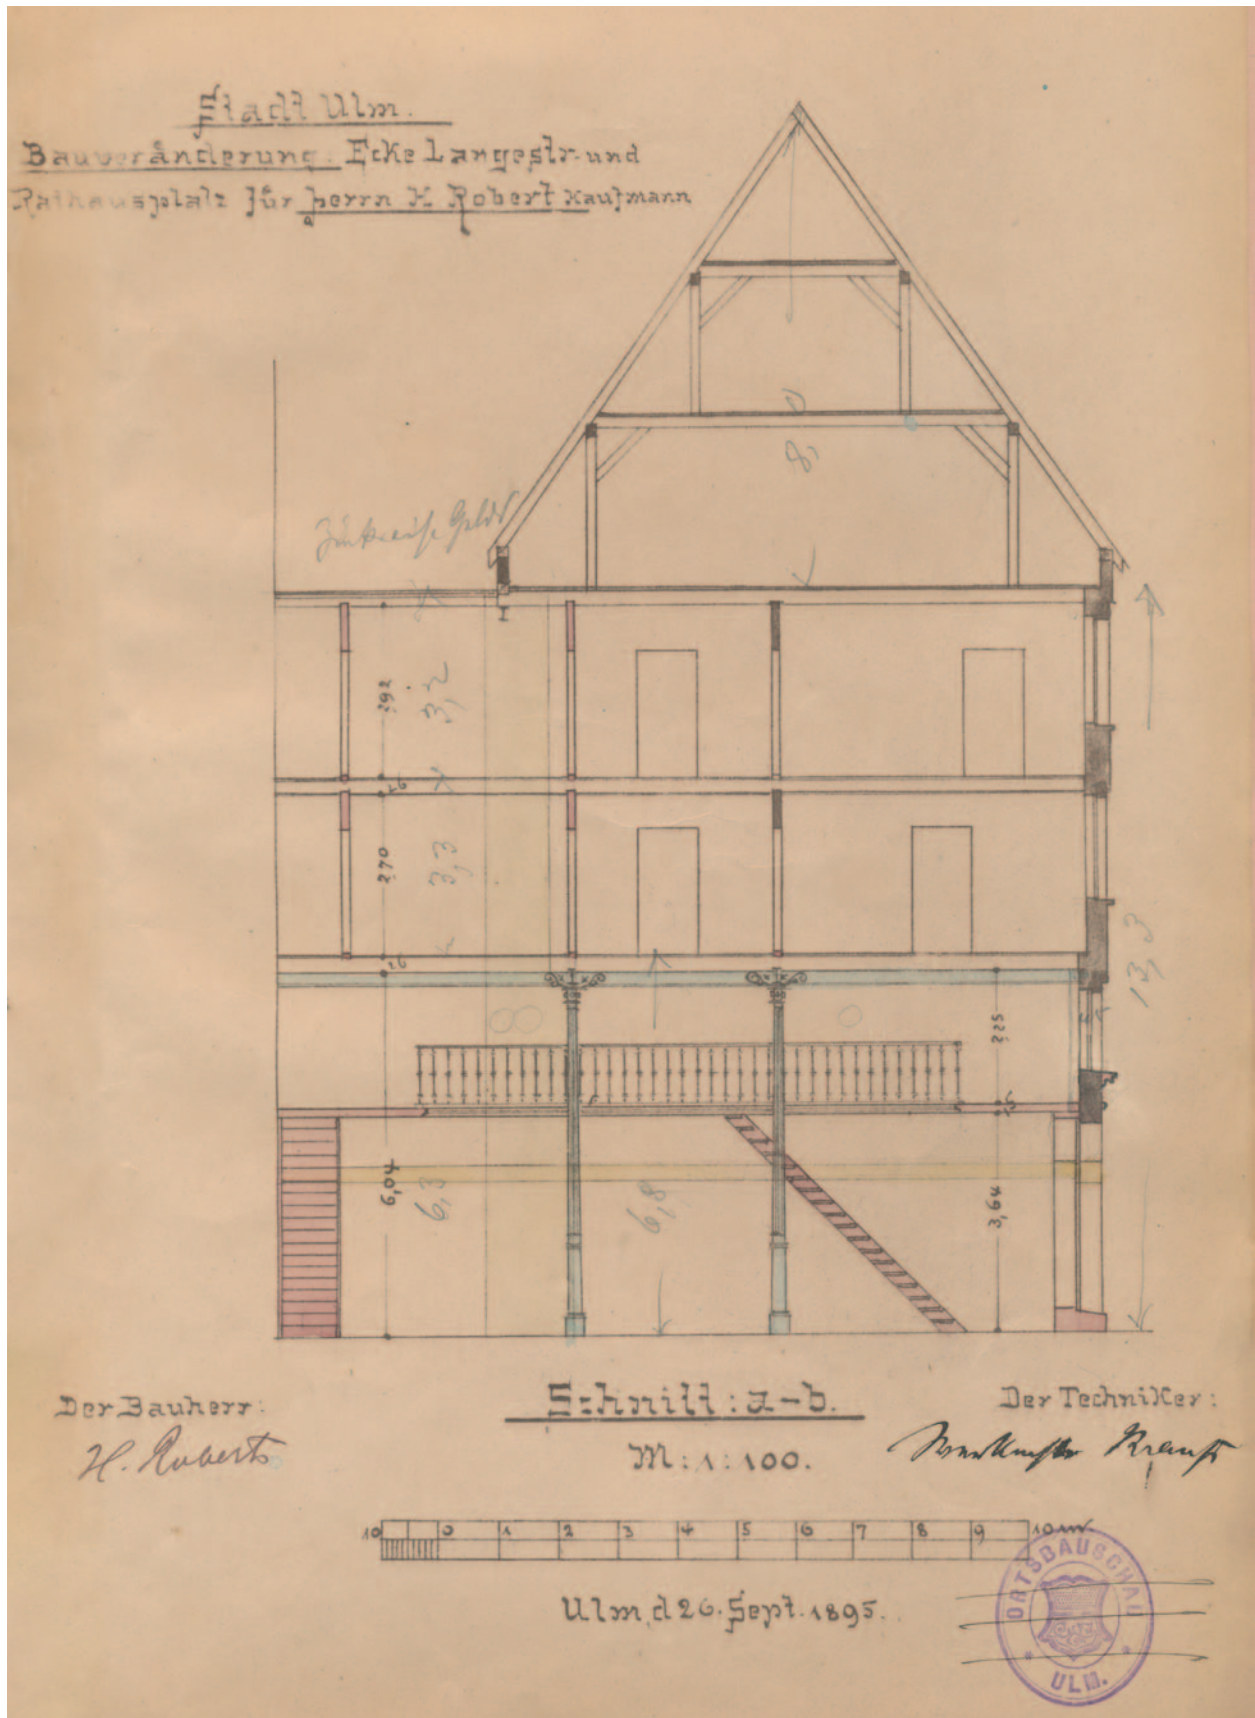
Gebäude Lange Straße 12 (A 259), am 7. November 1895 genehmigte Pläne zur Umbaumaßnahme des Hermann Robert. Schnitt des Hauses (Ost-West), der neben drei Stockwerkgrundrissen den Abbruch einer bis zum Dach reichenden ca. 150/110 cm starken Mauer dokumentiert. Rest eines Steinhauses?
